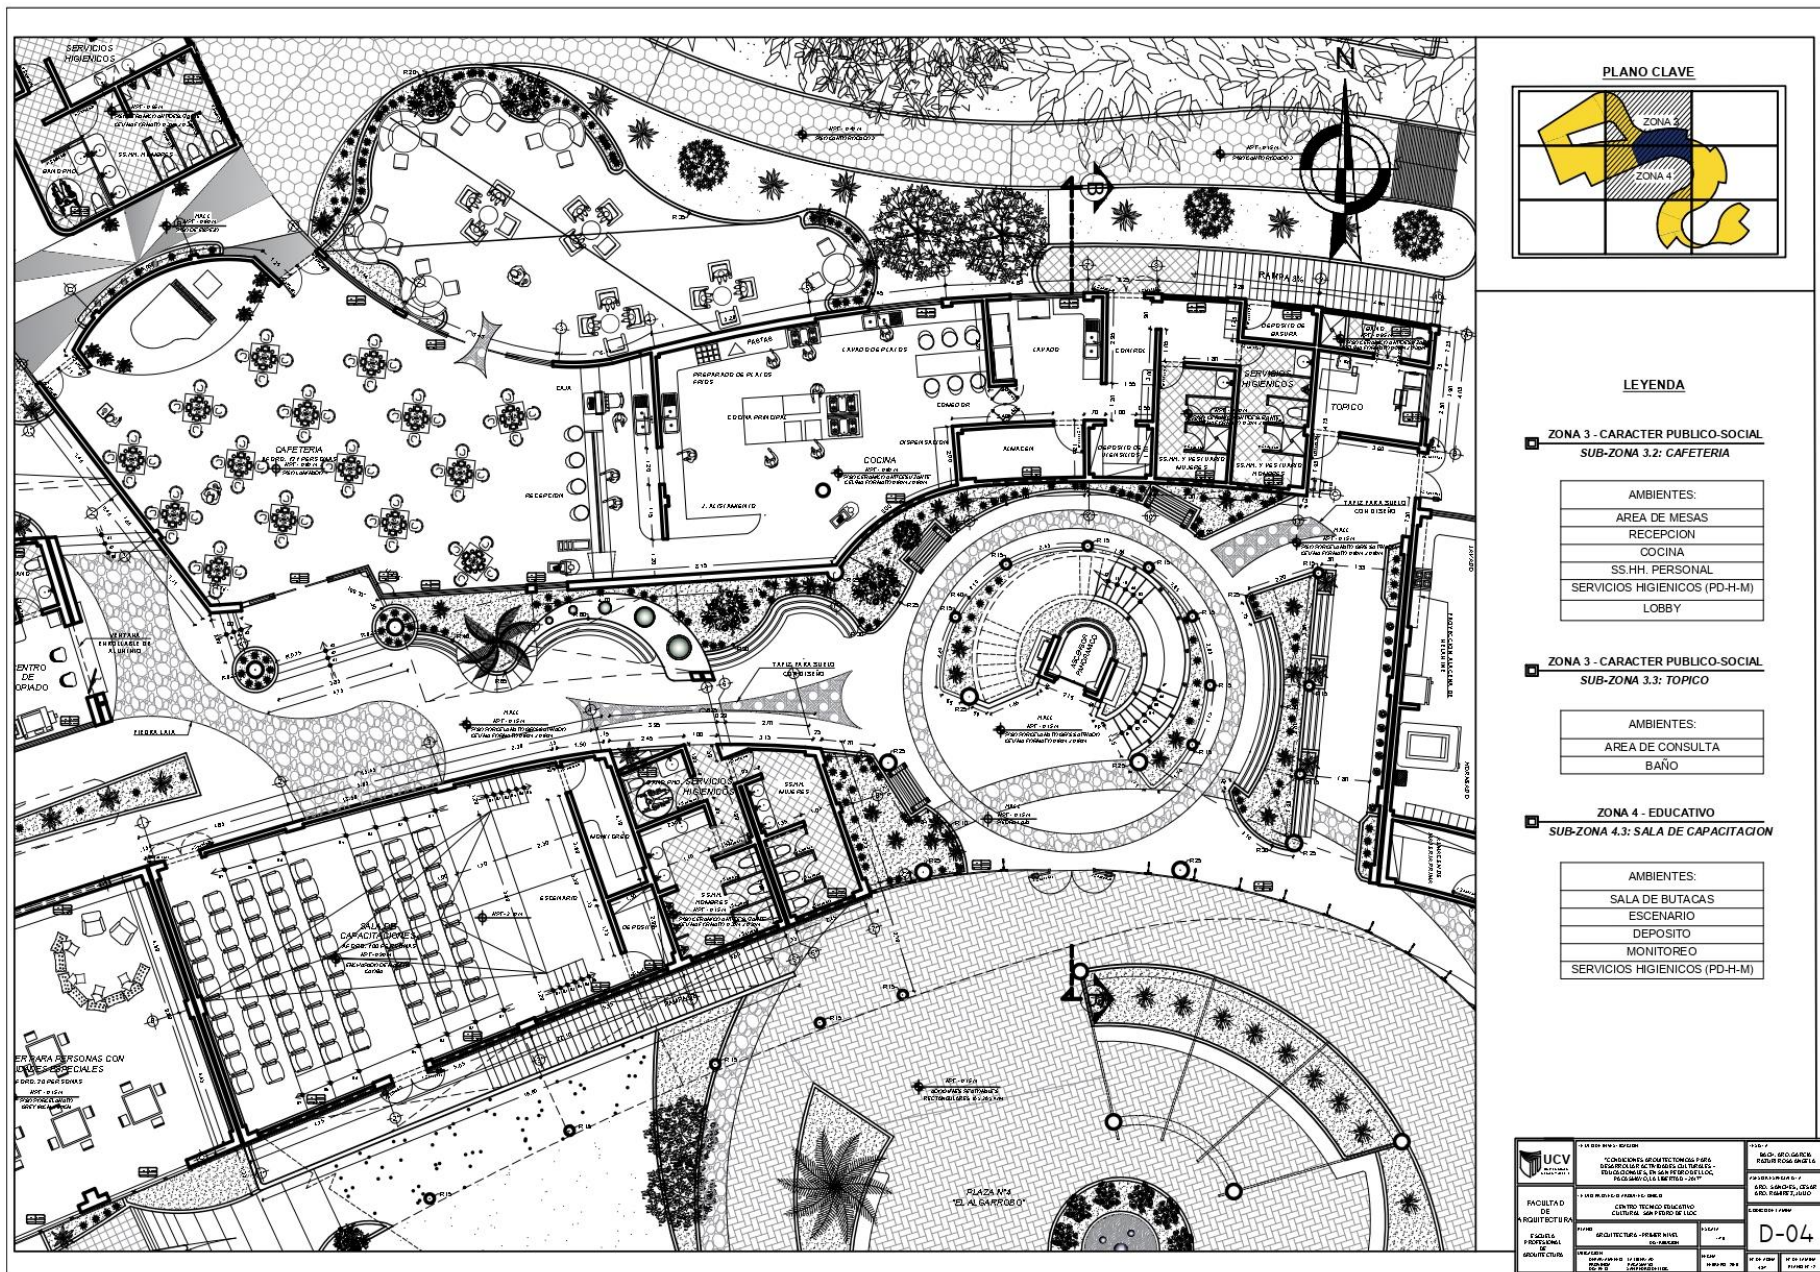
Plano de Desarrollo por Zonas - Plano N° 12 - Lamina N°: D - 04
